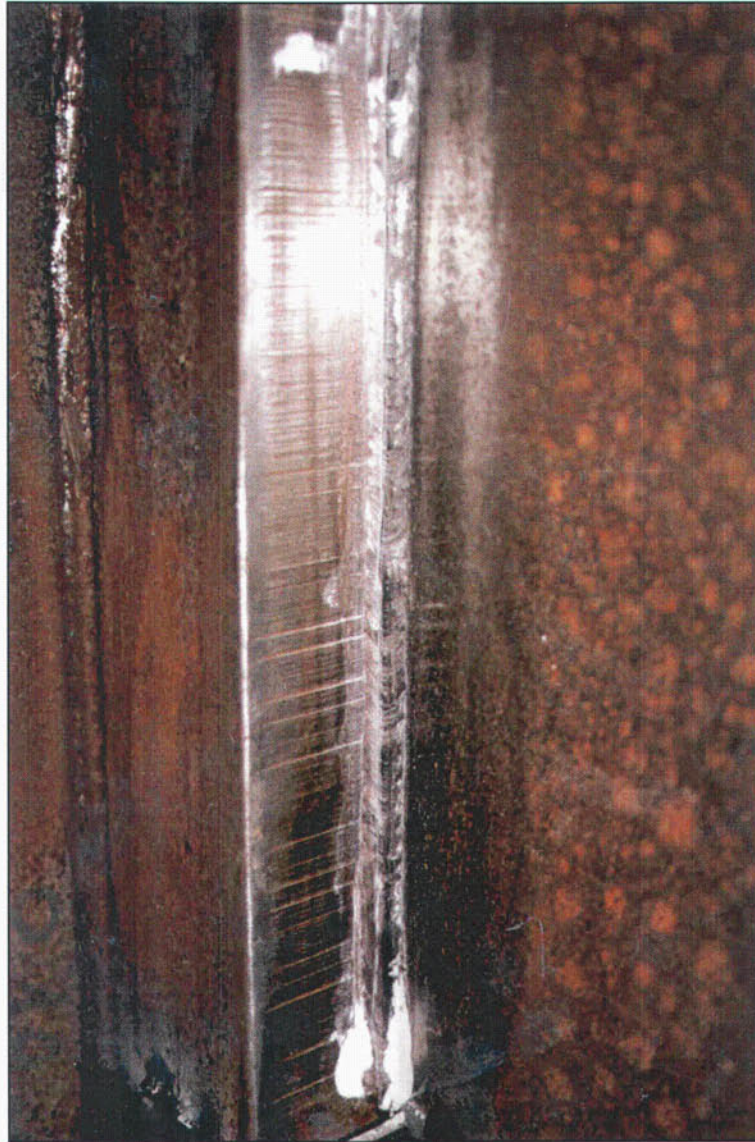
Nuevo detalle de la probeta 3M rota con las soldaduras limpias de cal, apreciándose el plano de rotura en la soldadura 5-7.
